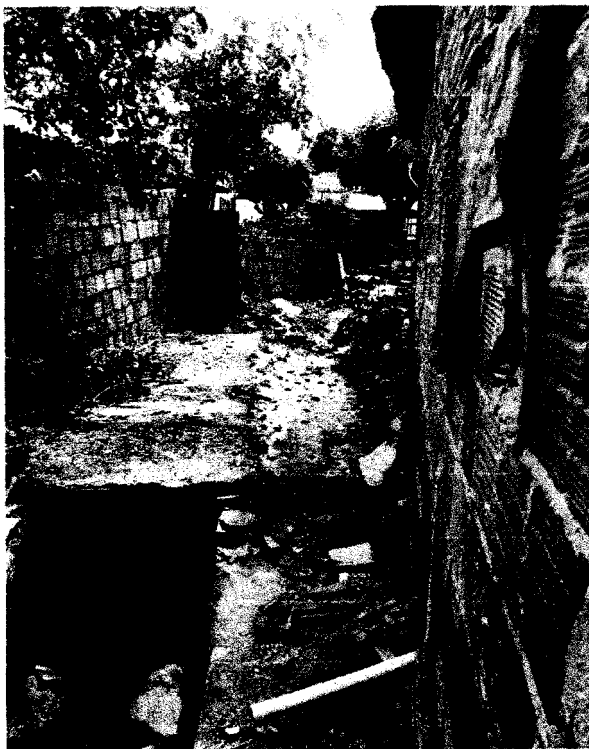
e 13 – Av. Tabelaio Francisco Alves – Execução de 2 Lajes de concreto.
